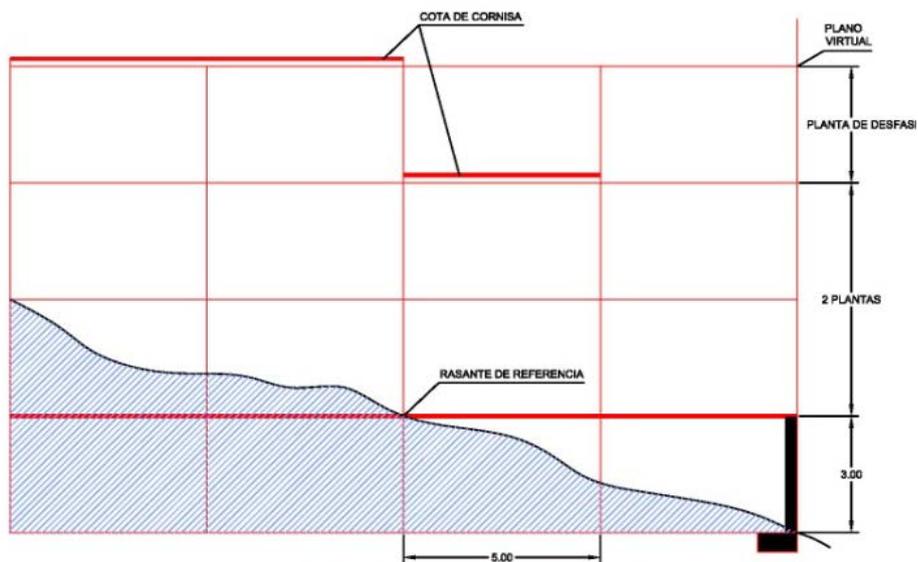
SECCION LONGITUDINAL - ENVOLVENTE EDIFICACION
